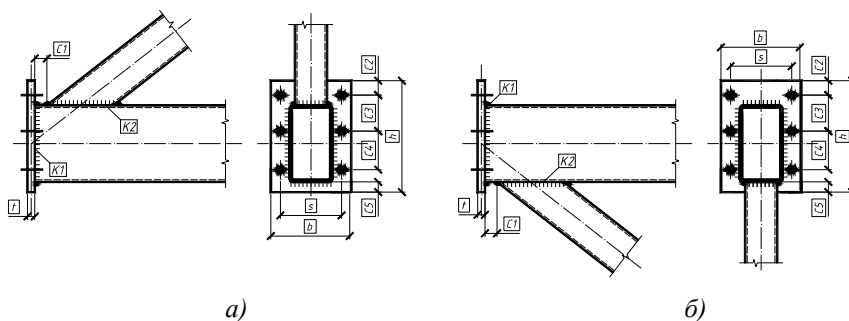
Опорные узлы ферм из прямоугольных (квадратных) труб
